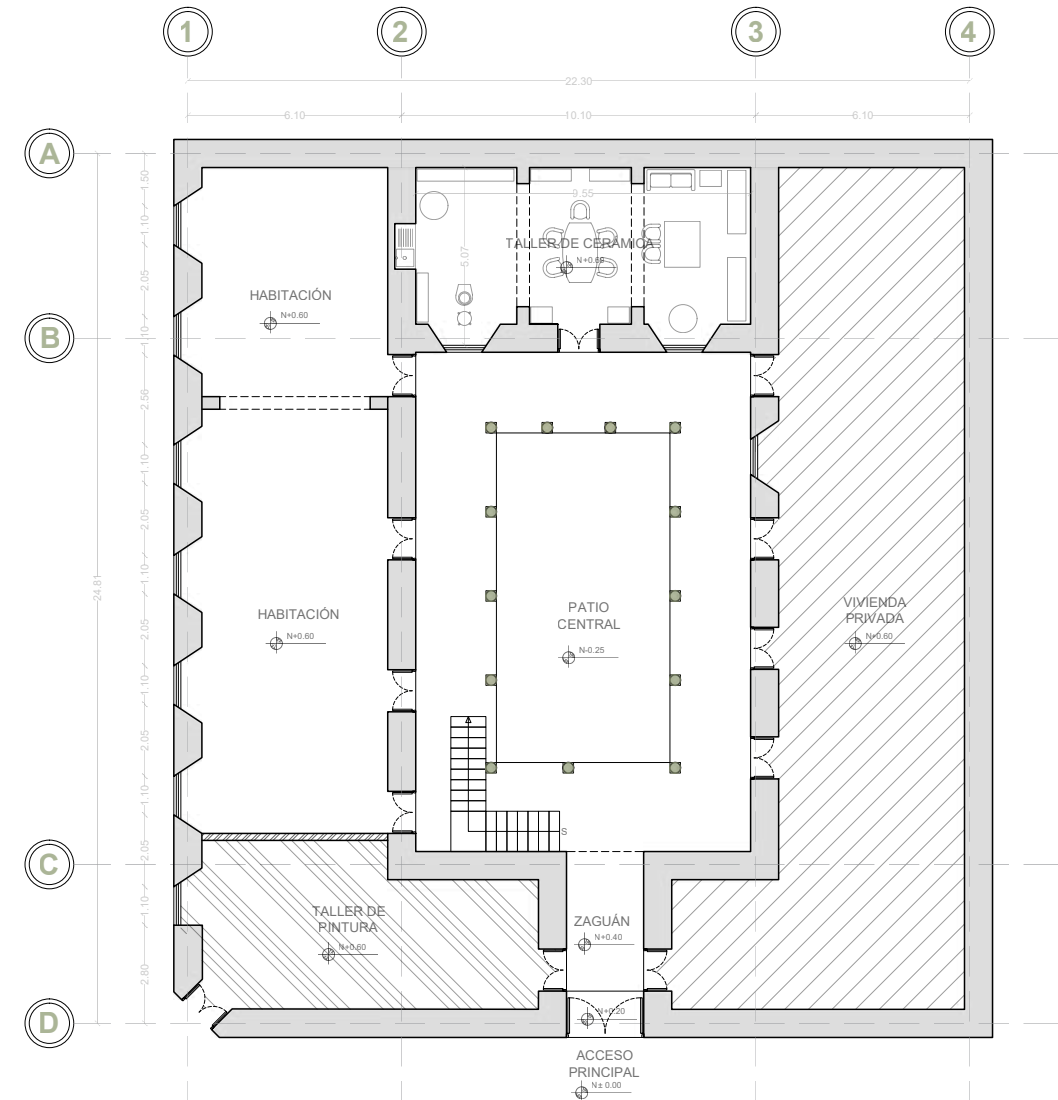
Fuente Levantamiento arquitectónico del autor
